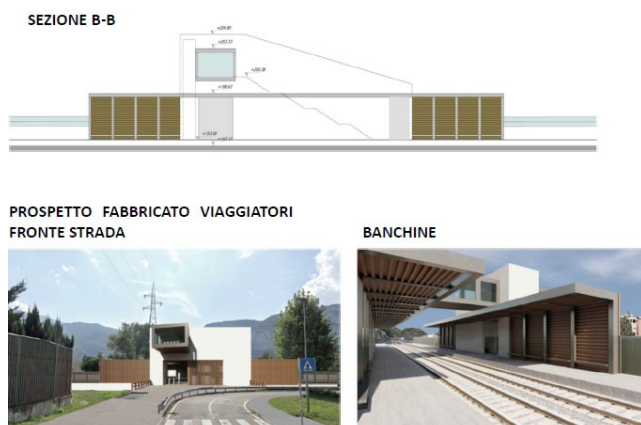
Rendering di progetto della futura stazione Trento Nord, fonte RFI.
